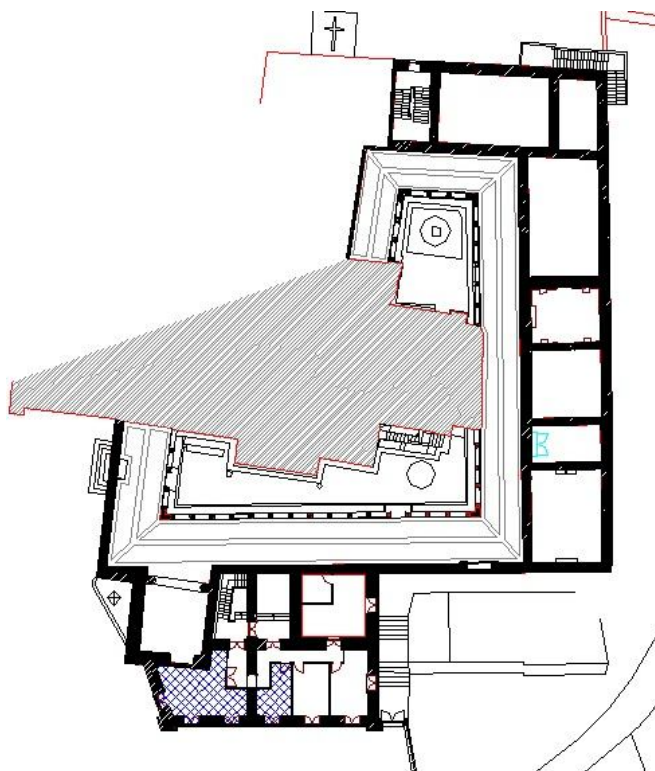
Marcação dos pavimentos do 1ºAndar. (Sem escala)
